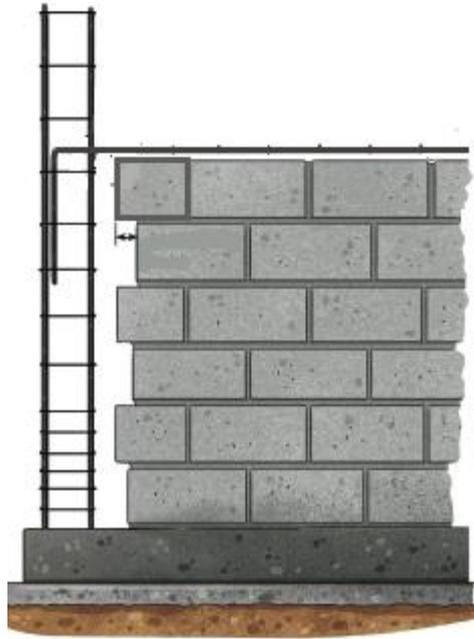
Proceso de construcción de cimentaciones corridas en mampostería confinada
